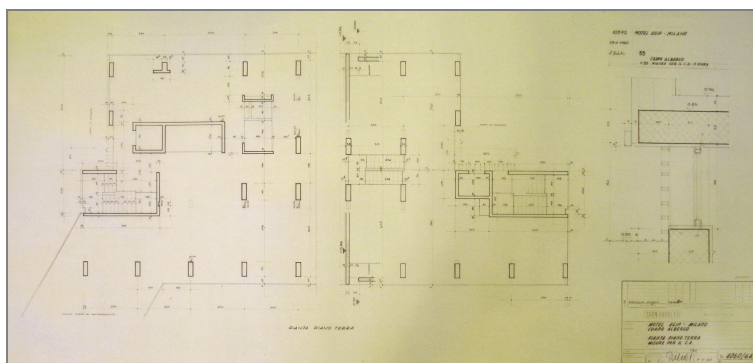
pianta piano terra – misure per il c.a. (fonte CSAC – tav. 33, archivio n. 181-2)
